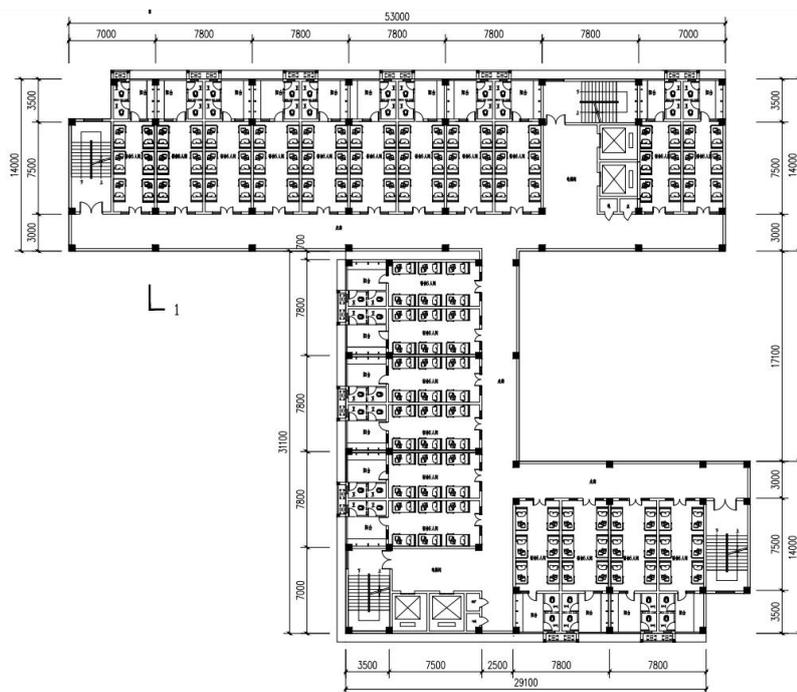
学生宿舍 9 号楼二至十三层平面布置图
